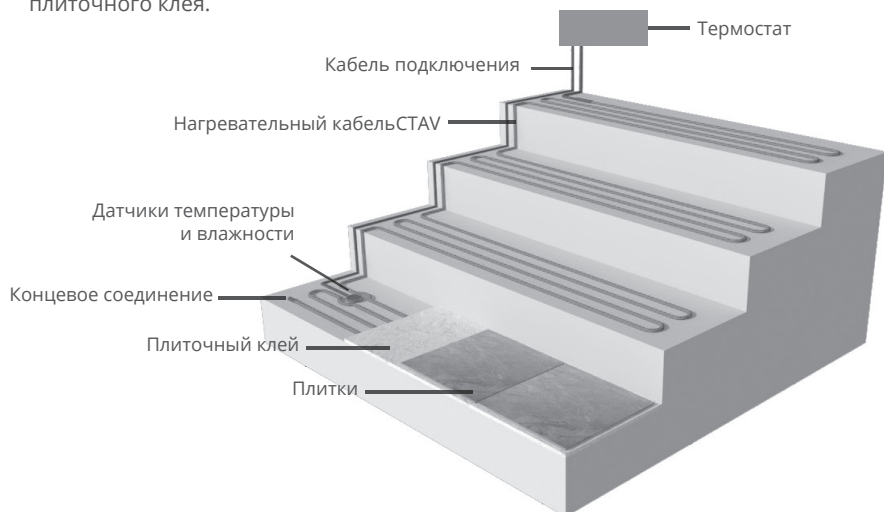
Укладка нагревательного кабеля в наружные ступени
